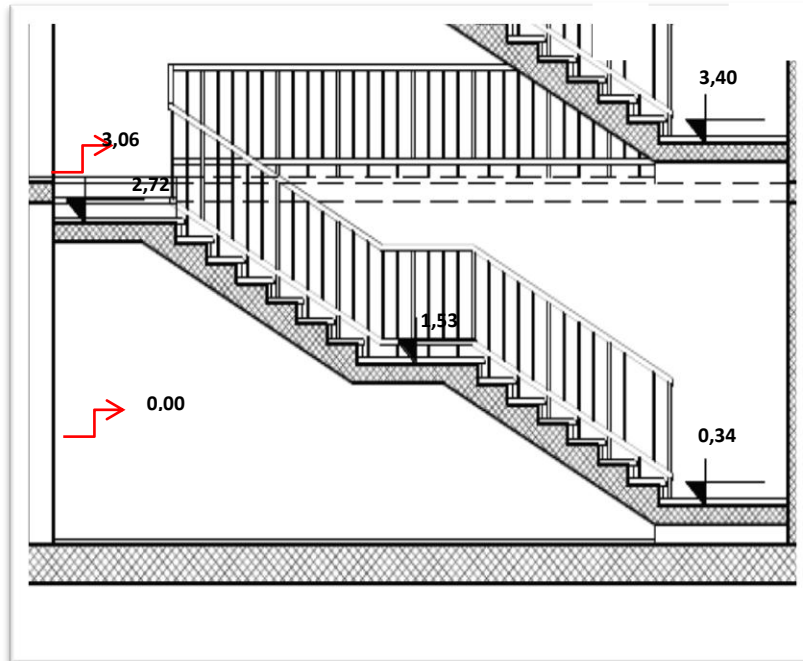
escalier gauche avec pallier intermédiaire et paillasse porteuse
